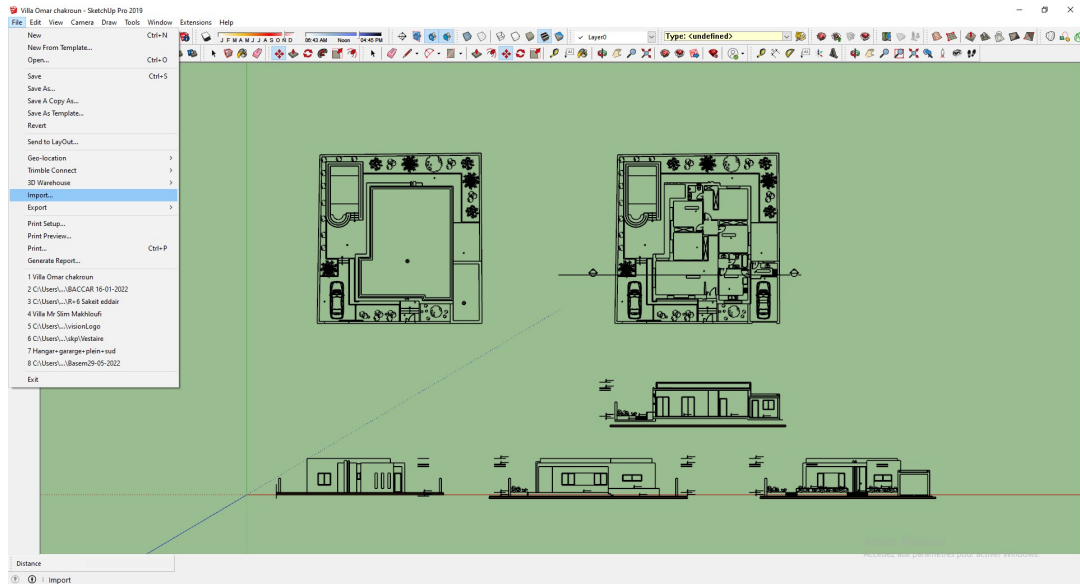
Importation du plan AutoCAD de la maison au SketchUp
